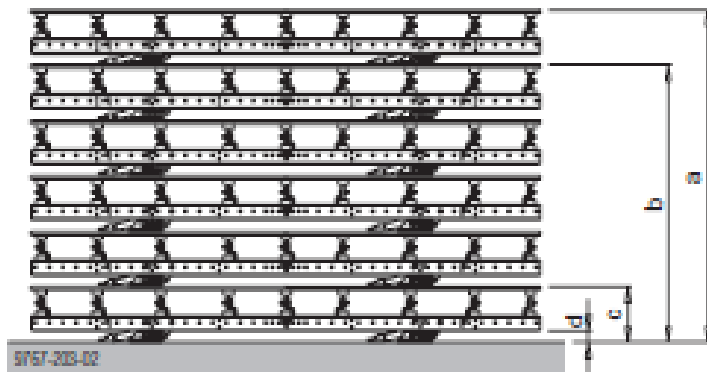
Encofrado de Mesas con soportes cimbra para ejecución del pico de la vela.2007.Raúl López
